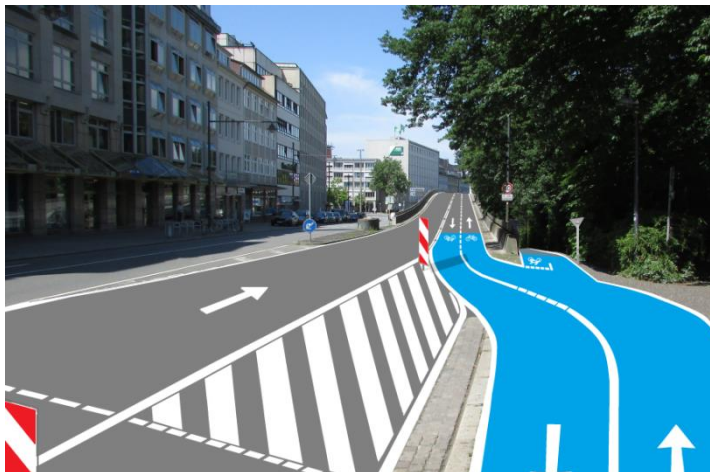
Führung der Premiumroute vom Radweg Am Wall auf die Hochstraße (Fahrrichtung Westen)
